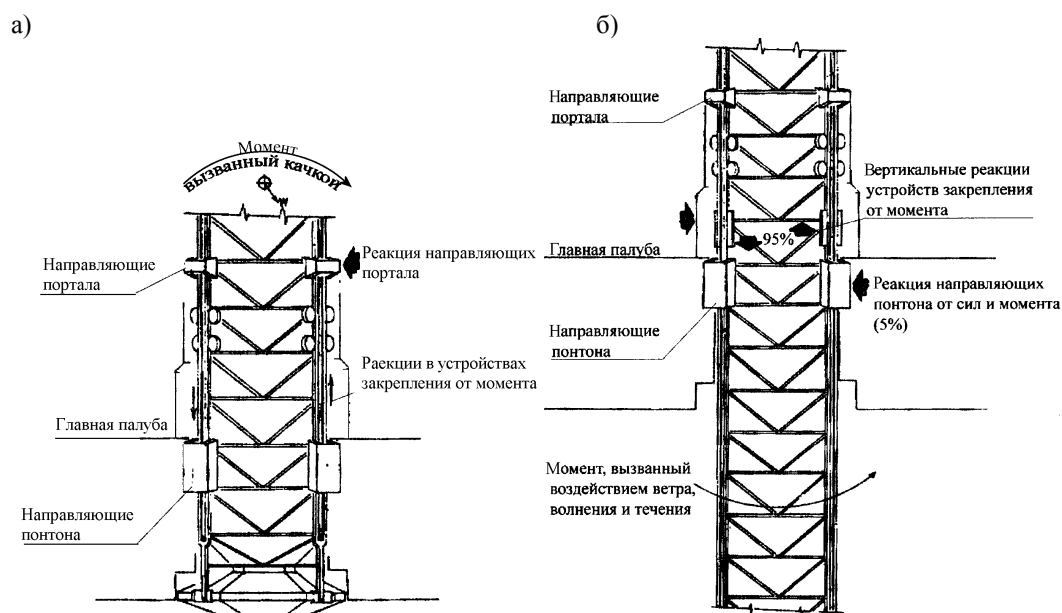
Режим транспортировки на плаву (с устройствами закрепления опор):
